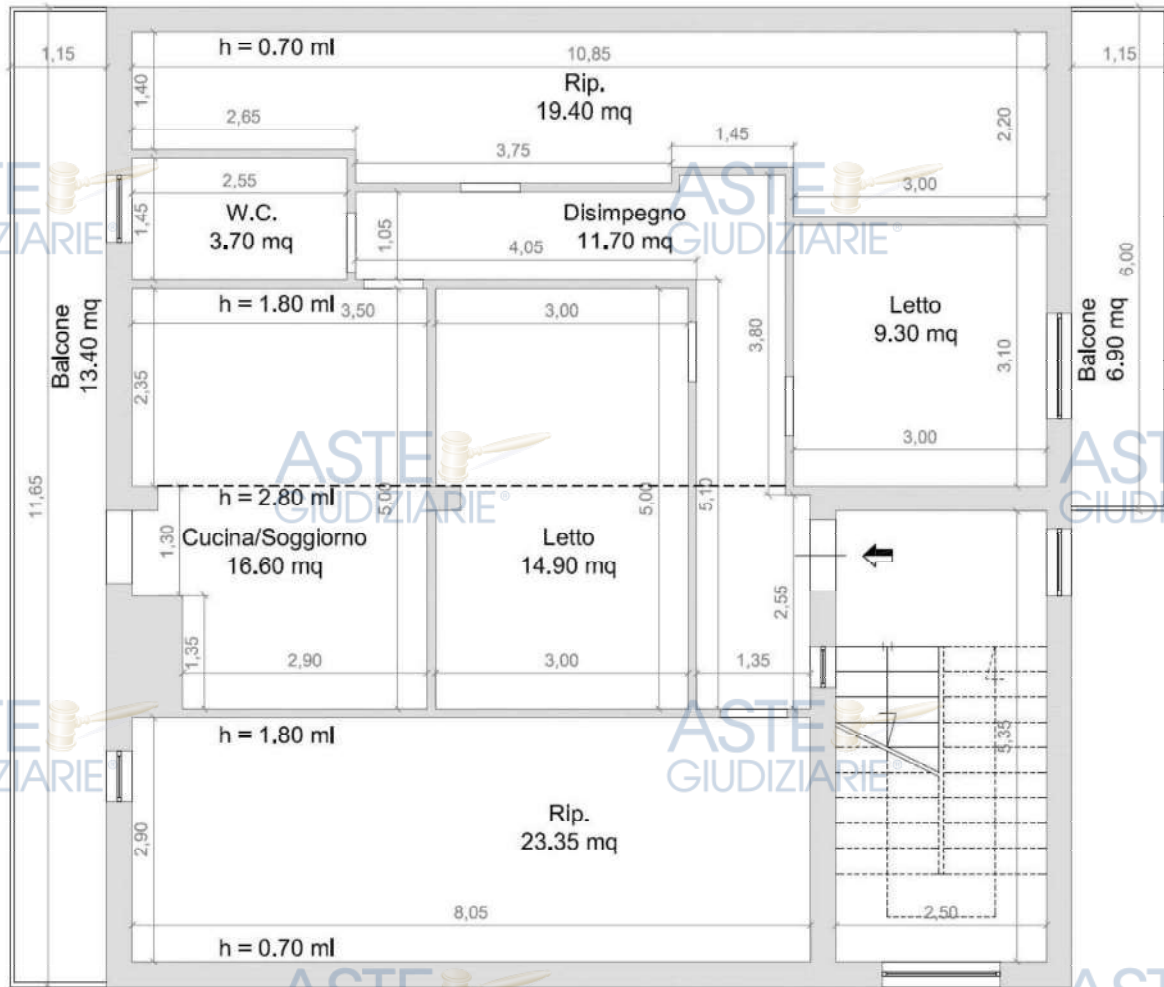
Planimetria Stato di Fatto Abitazione Piano Secondo, P.IIa 402, Sub 3.
